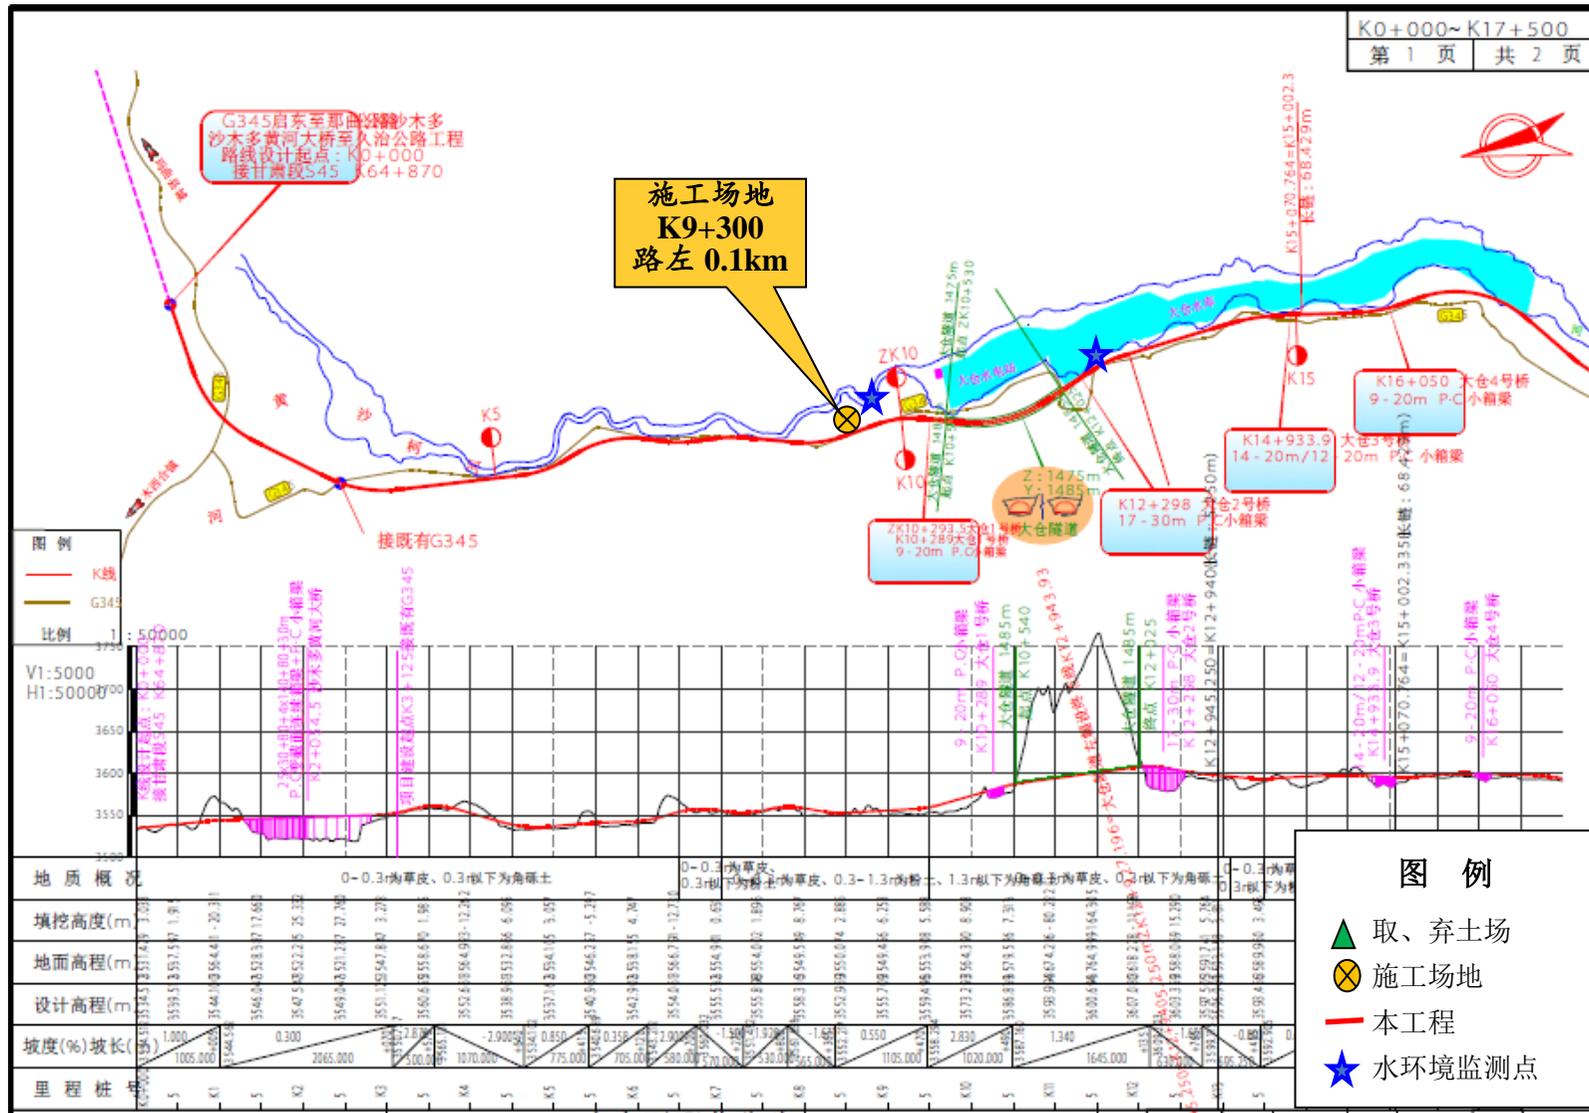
本工程路线走向及线位总体平面布置示意图 (1)
